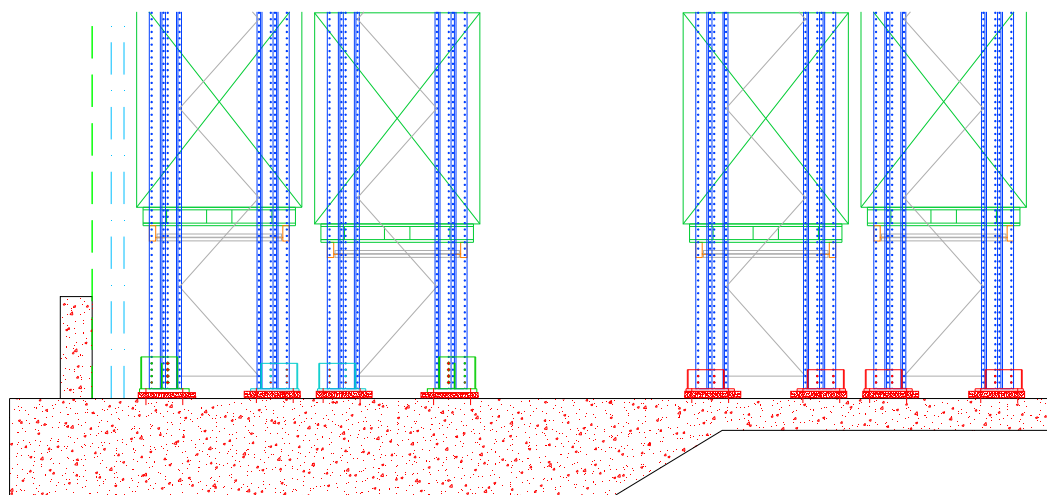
SECCION TIPO DE CIMENTACIÓN DE SILO AUTOPORTANTE
